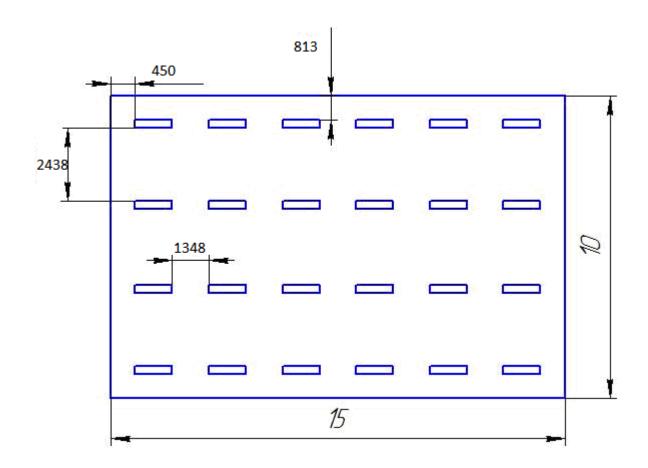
План помещения и размещения светильников с люминесцентными лампами.
